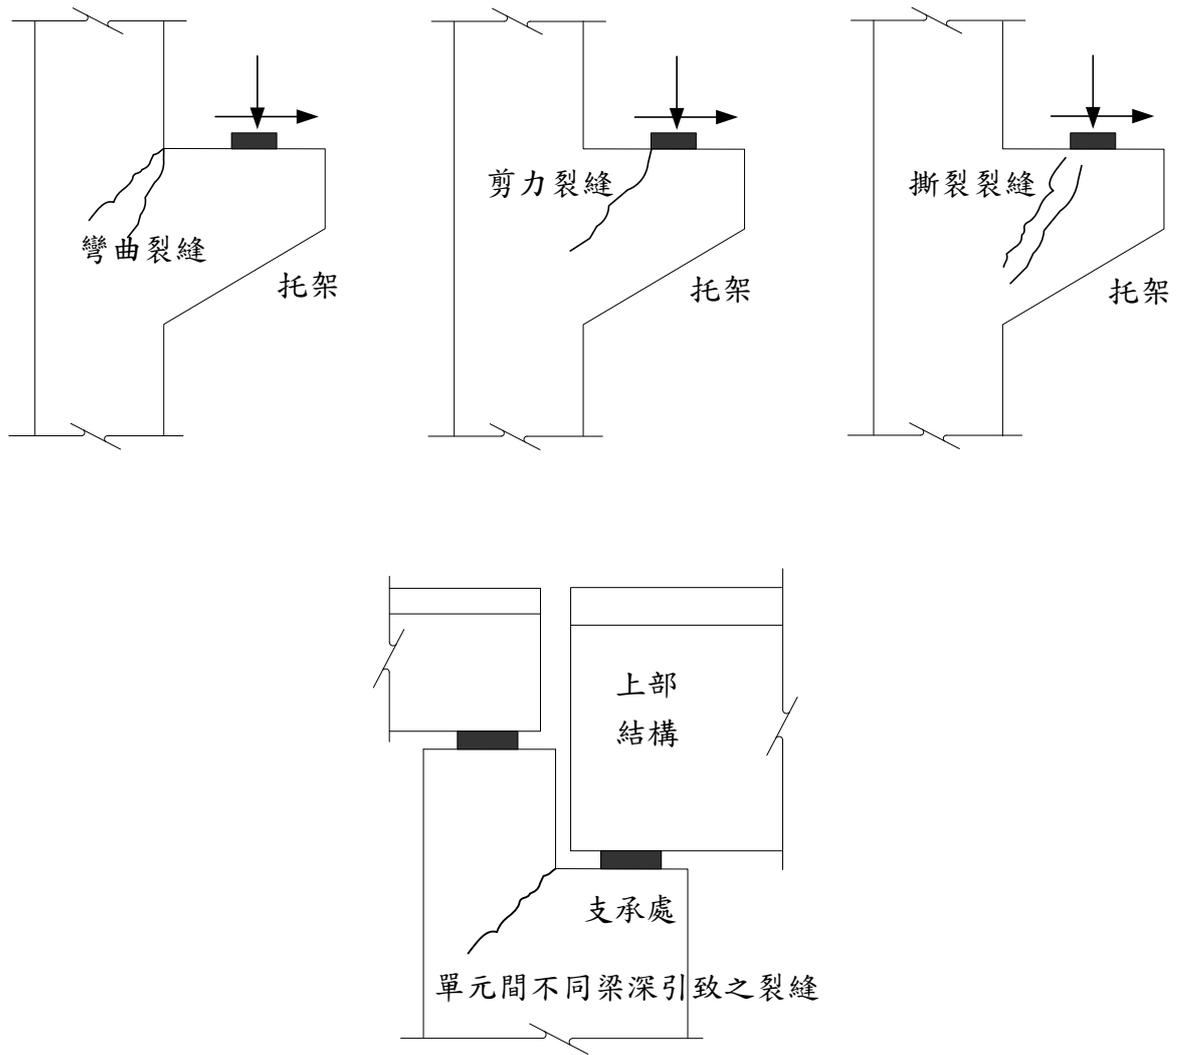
混凝土托架及支承處裂縫示意圖
